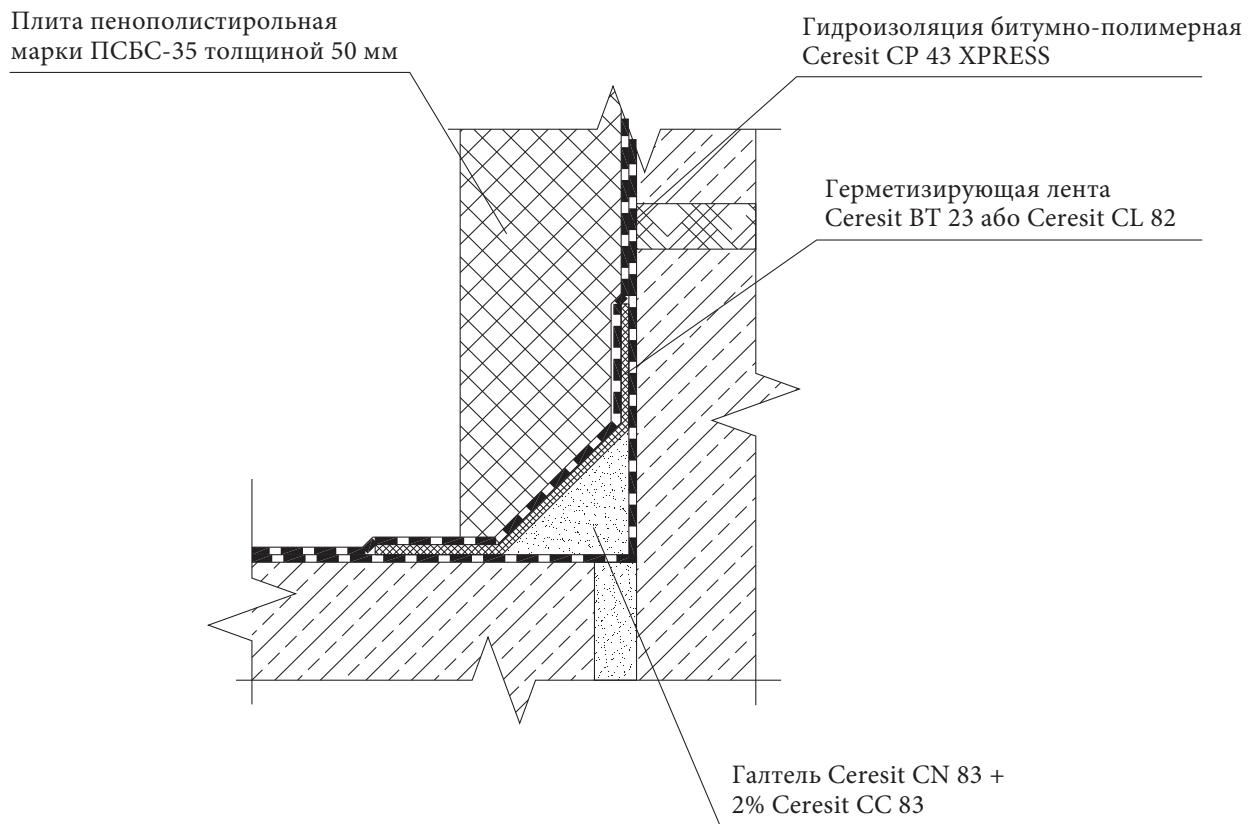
Усиление наружной гидроизоляции в месте примыкания стены к фундаменту (узел В)
